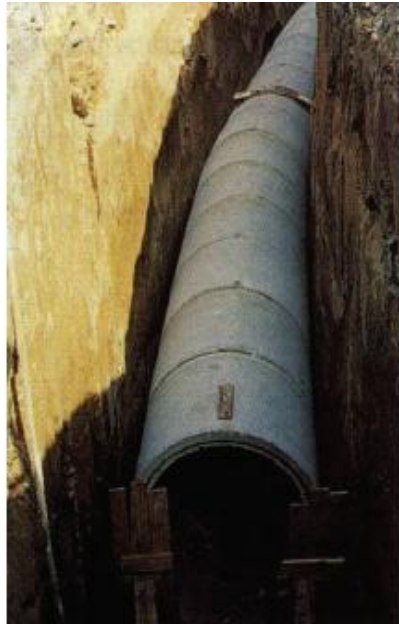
Espacio insuficiente entre la conducción y las paredes de la zanja, haciendo imposible la compactación por debajo del plano medio
